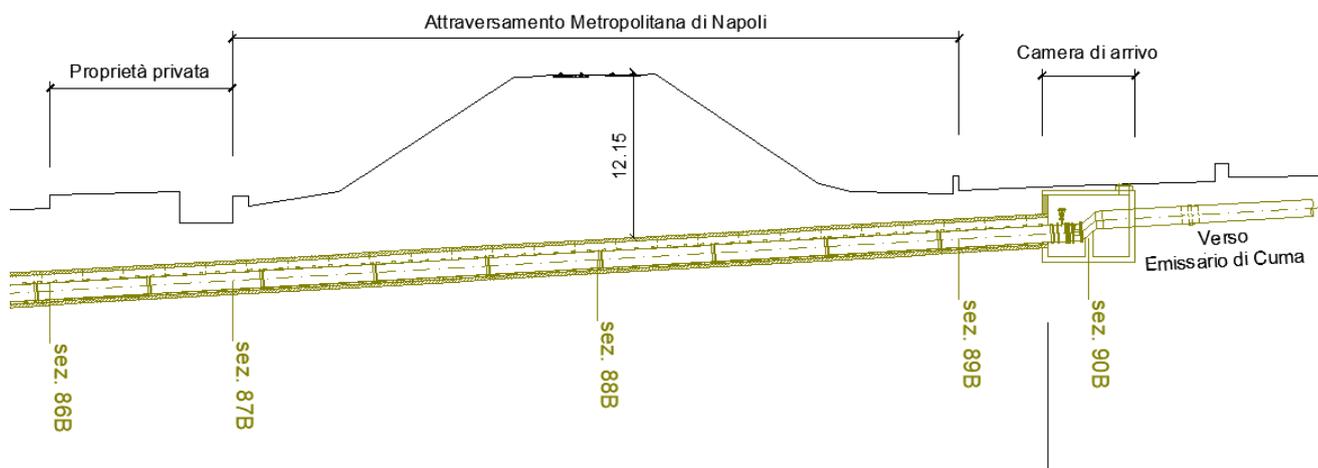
Dettaglio attraversamento della Ferrovia Metropolitana Linea 2
